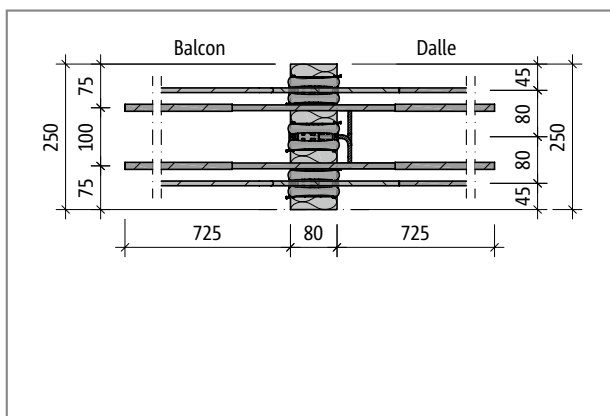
Schöck Isokorb® T Type K-E-M6 : Plan de base du produit de la variante L250
